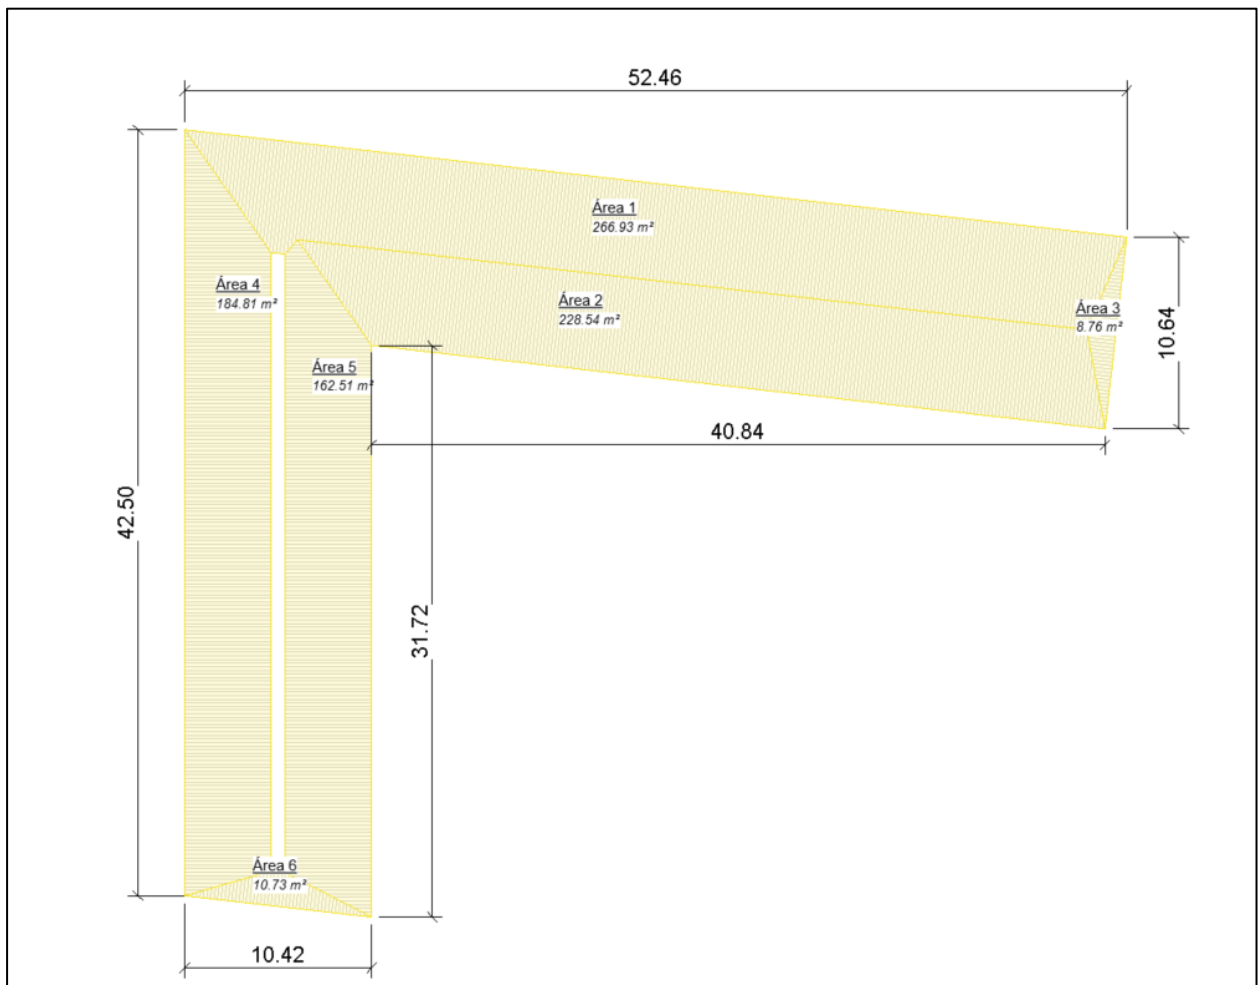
Áreas de distribución de las secciones del techo. (Jaén y Medina, 2023)
